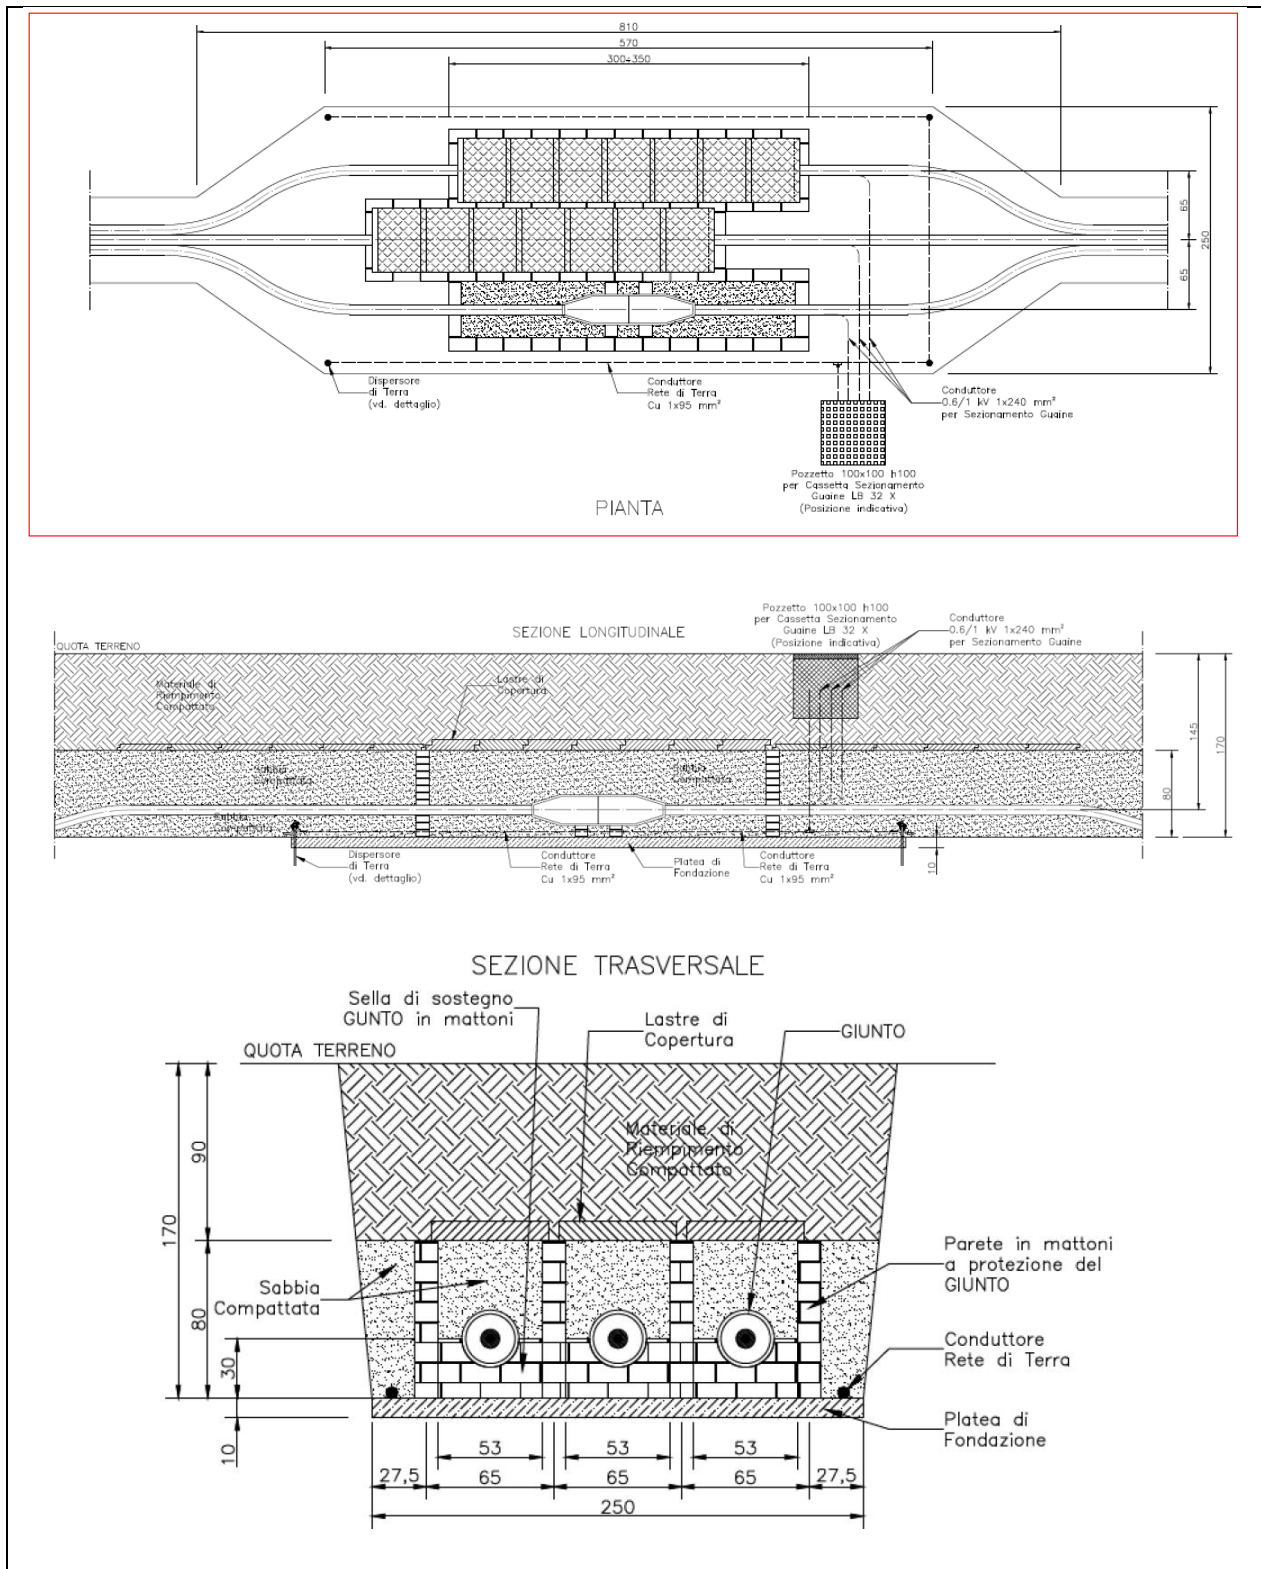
PIANTE E SEZIONI DEL TIPICO CAMERA DI GIUNZIONE
